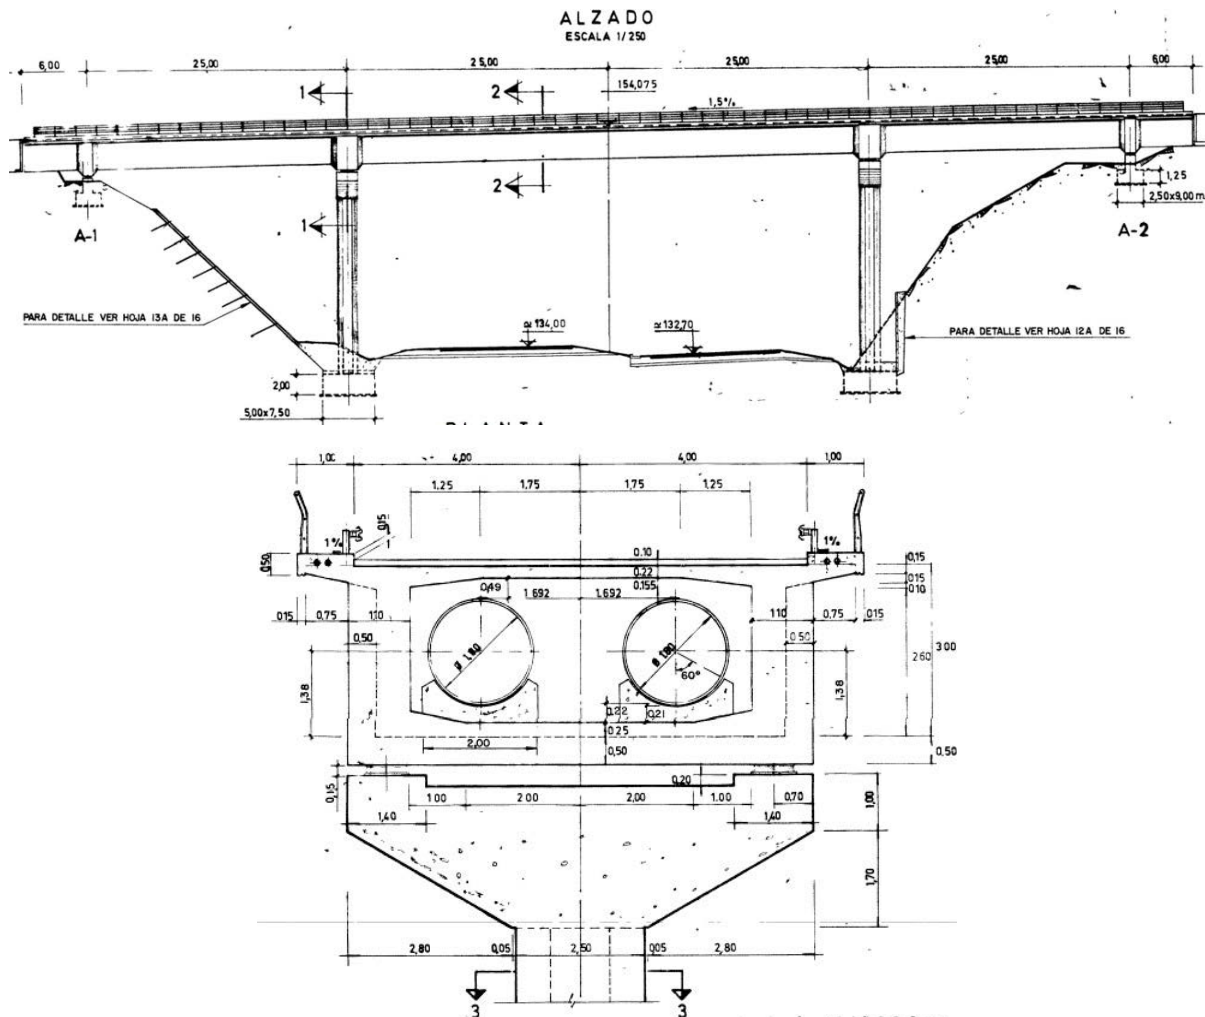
Alzado y sección transversal del acueducto. Planos originales.
